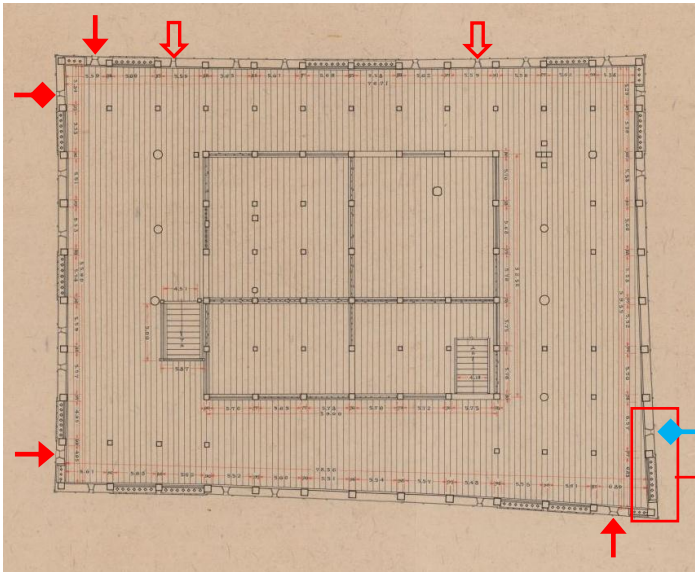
2階平面図 (部分) 姫路市立城郭研究所蔵
